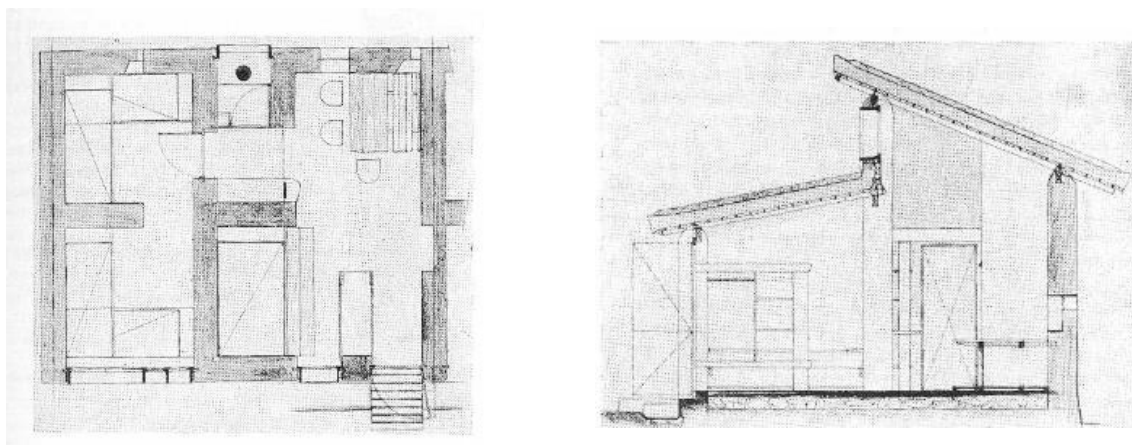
Planta e Corte Habitação “*Murondins*” respetivamente
